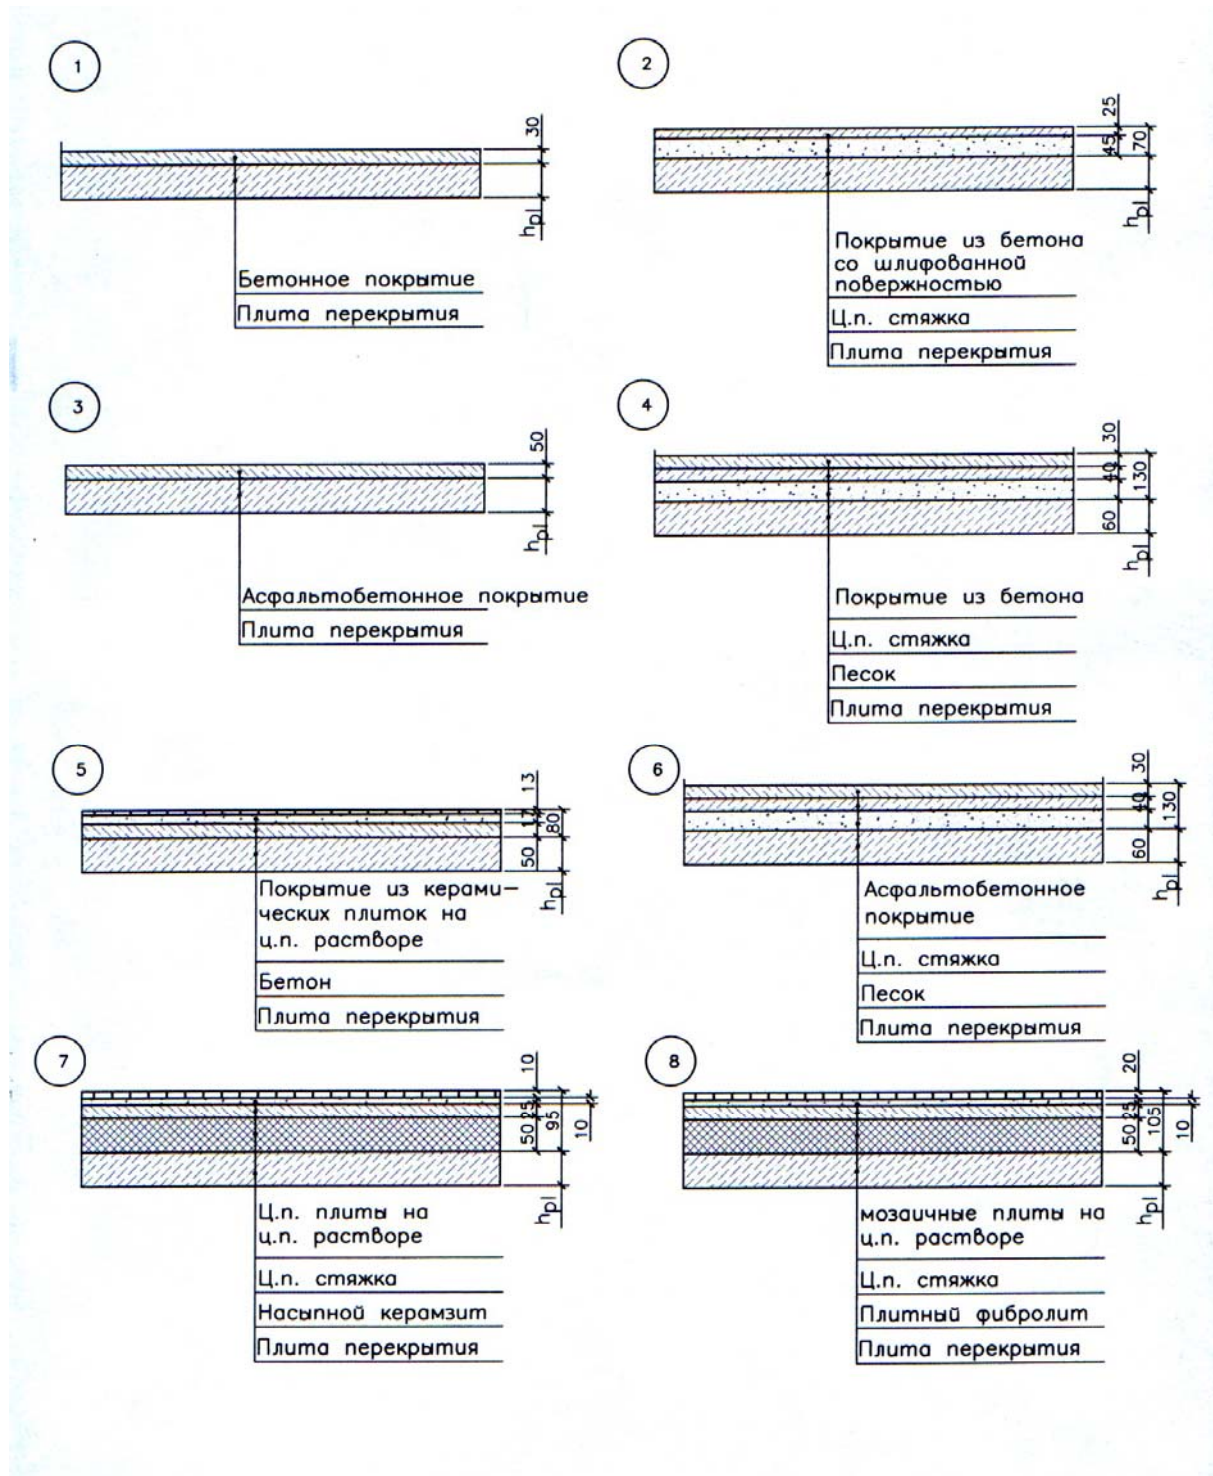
Варианты конструкции пола на перекрытиях промзданий
